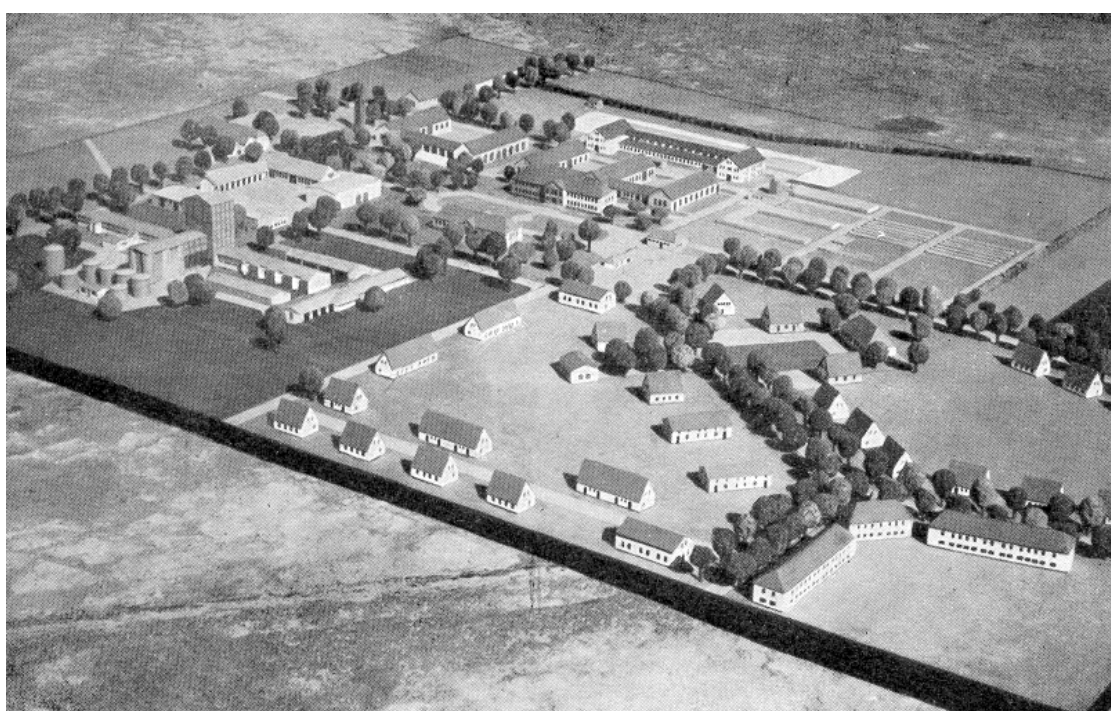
Modellaufnahme des Instituts nach dem Generalbebauungsplan
